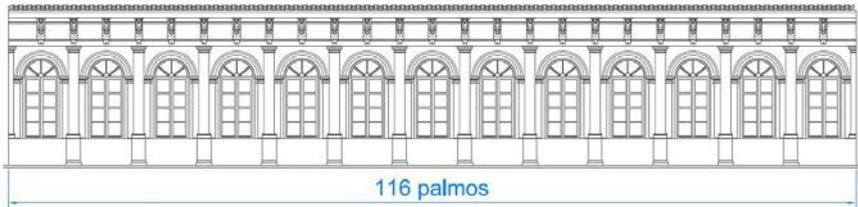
Claustro Superior vista general. 2016. Plano del autor.
